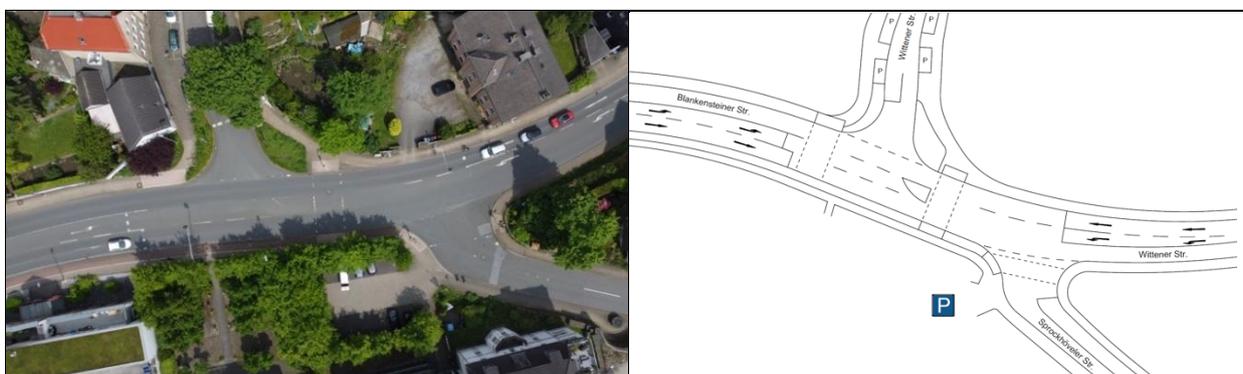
Luftbild und Plan „Wittener Straße / Sprockhöveler Straße“
